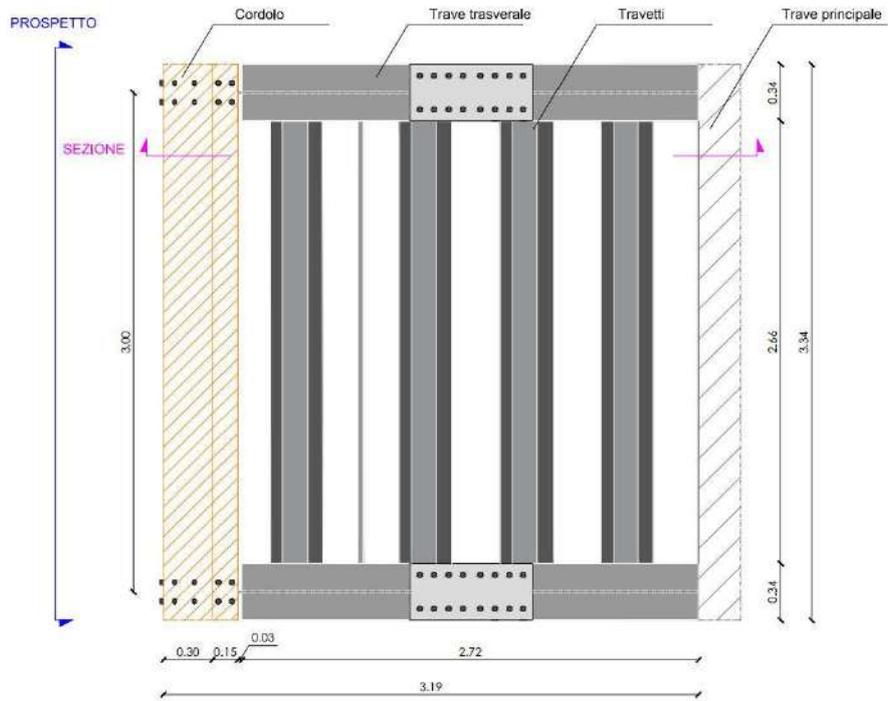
Planimetria soletta a sbalzo del viadotto.
